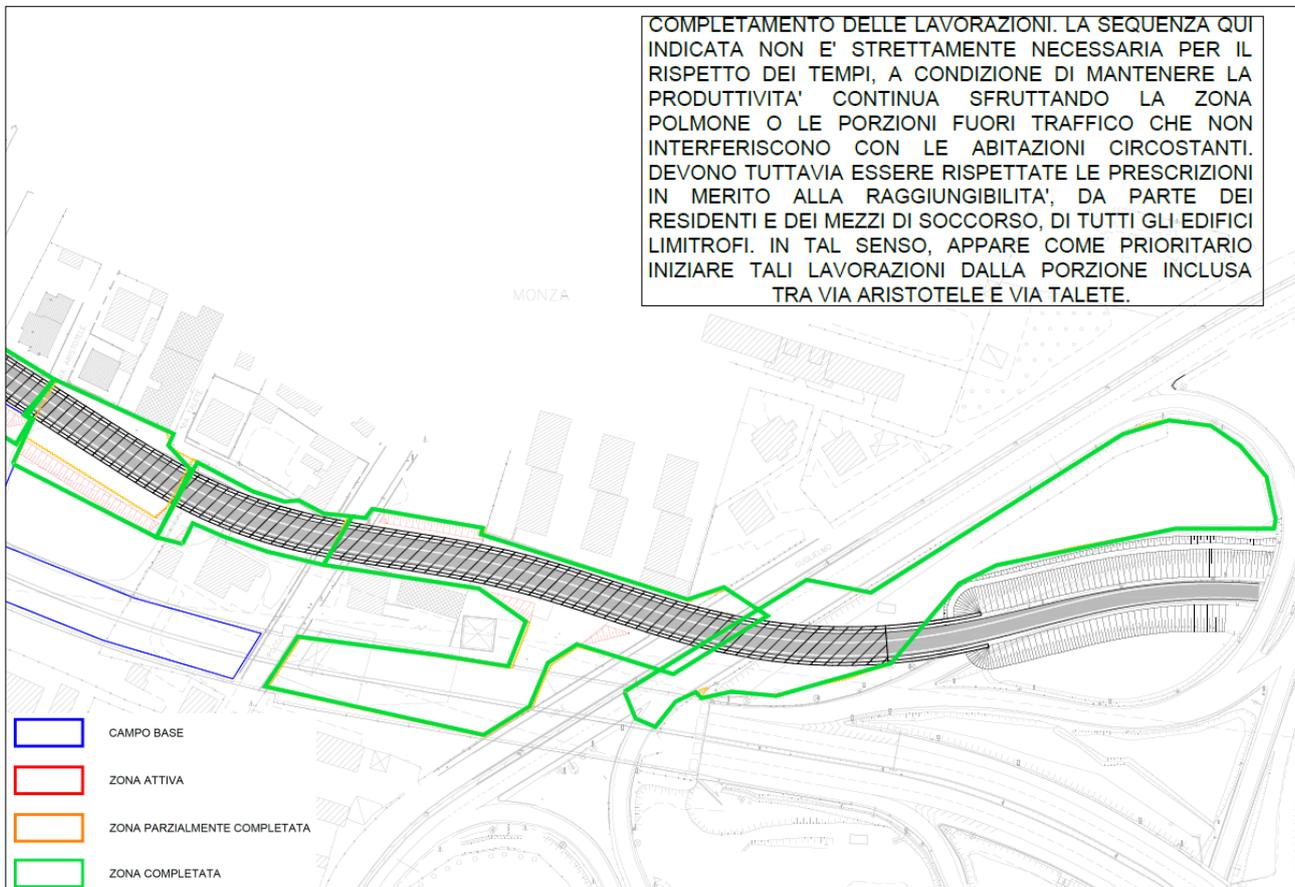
Fasi realizzazione copertura galleria del Piano di Sicurezza di progetto illustrativo della fase H di scavo della galleria.
